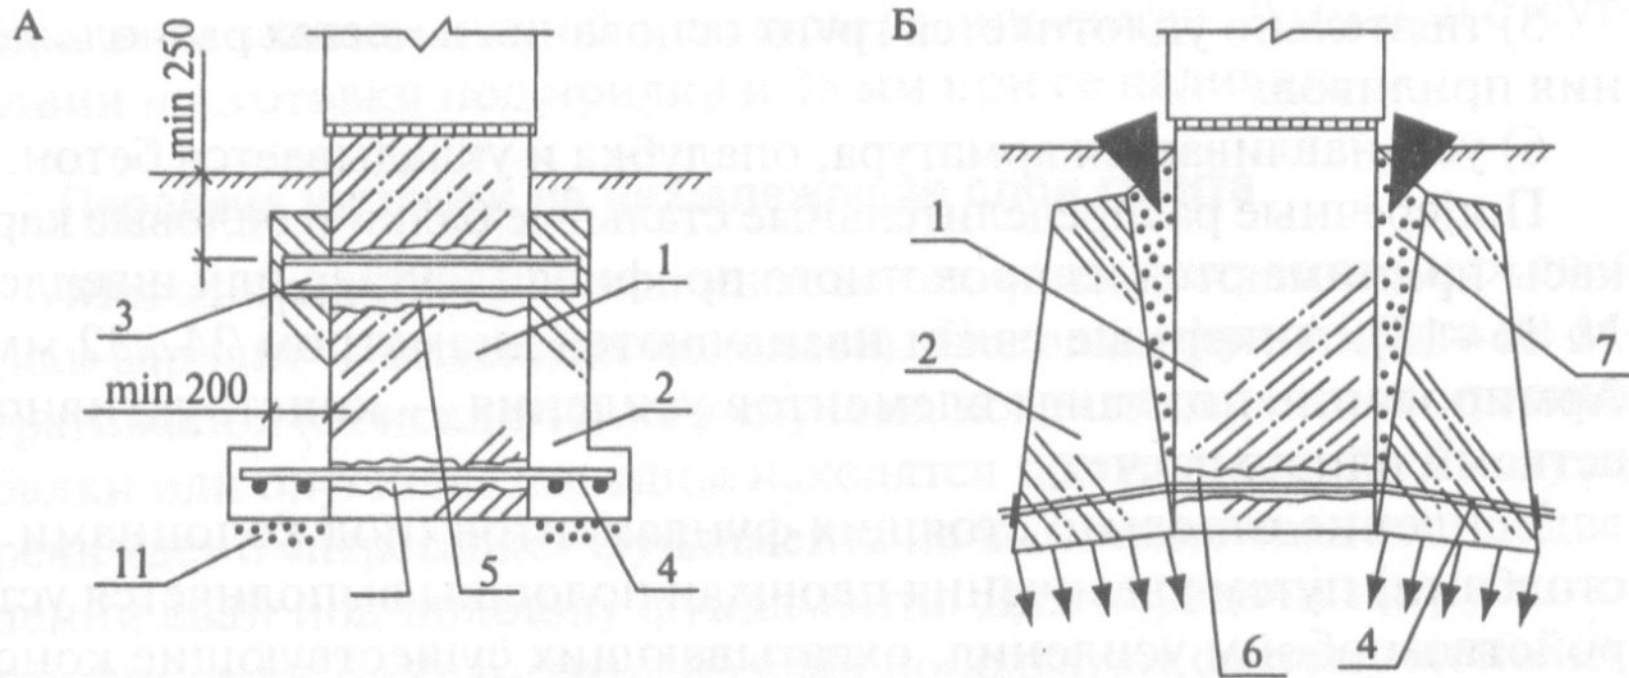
Увеличение опорной площади ленточных фундаментов с помощью приливов:
